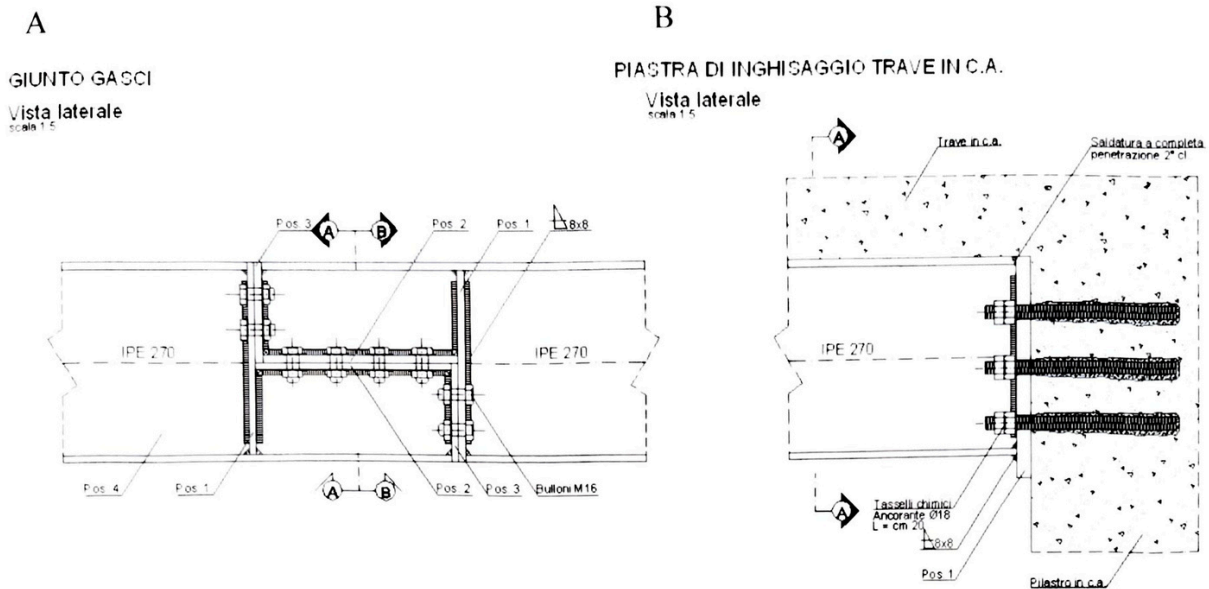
A) Particolare del giunto GASCI; B) Particolare del collegamento trave di collegamento -pilastro.
